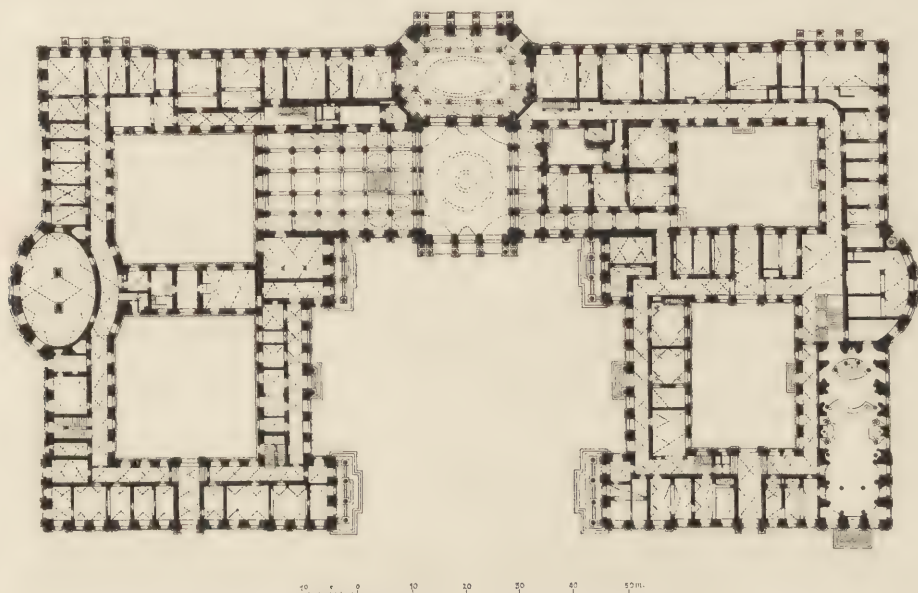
Residenz zu Würzburg. Grundriß des Erdgeschosses.
